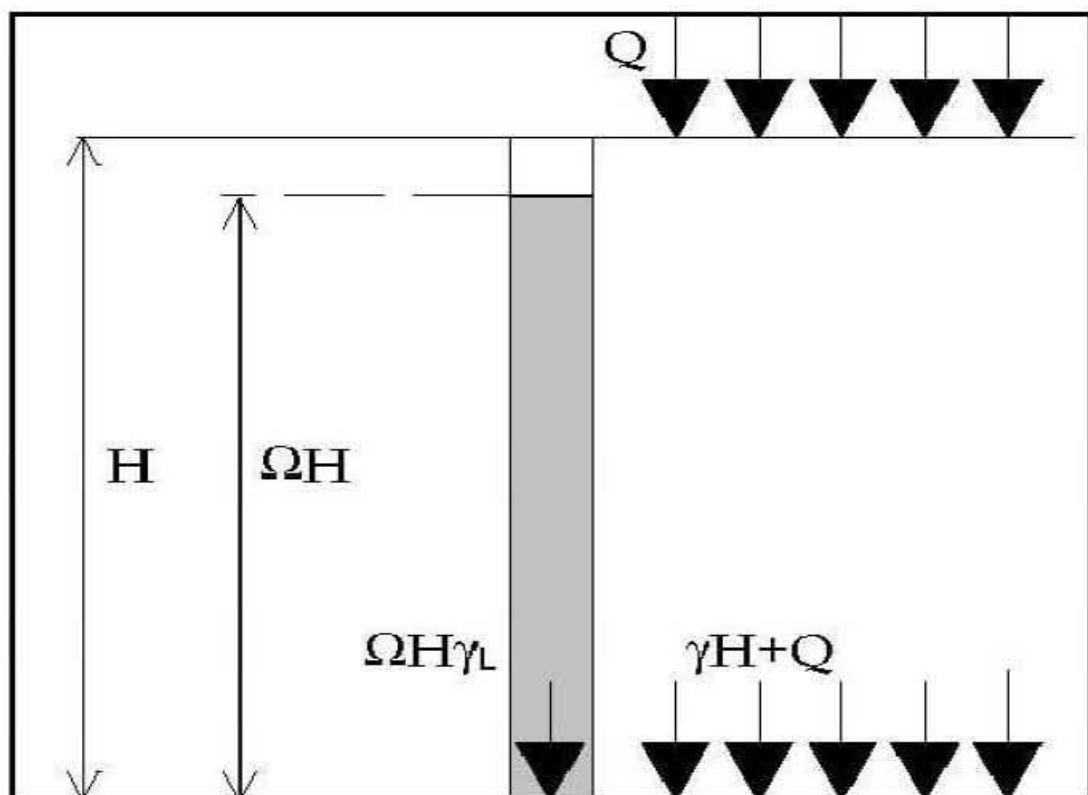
Esfuerzos en el fondo de la trinchera.
